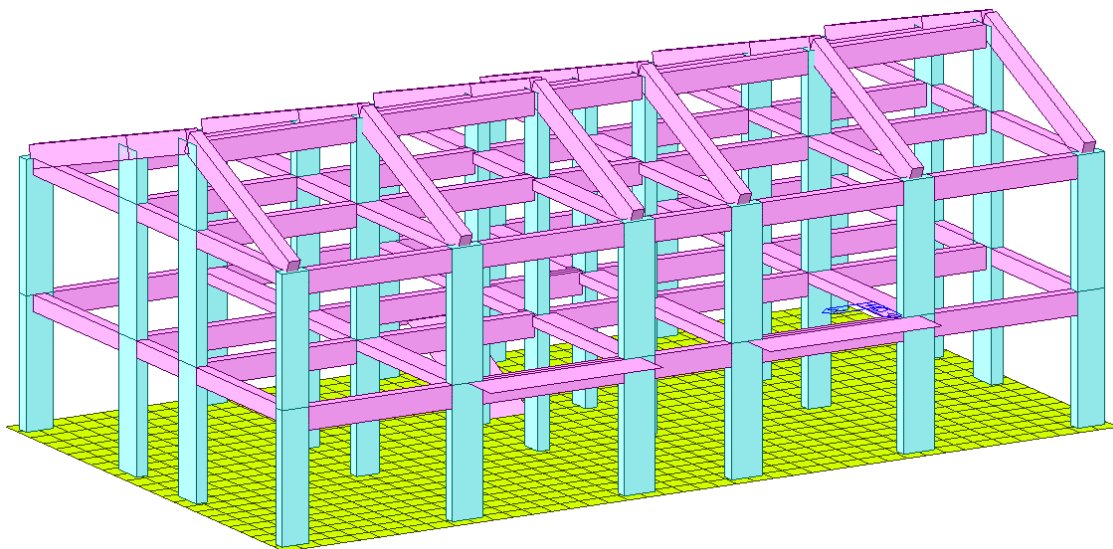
Modello FEM edificio a due piani in c.a. con platea di fondazione - Vista assometrica 2.
